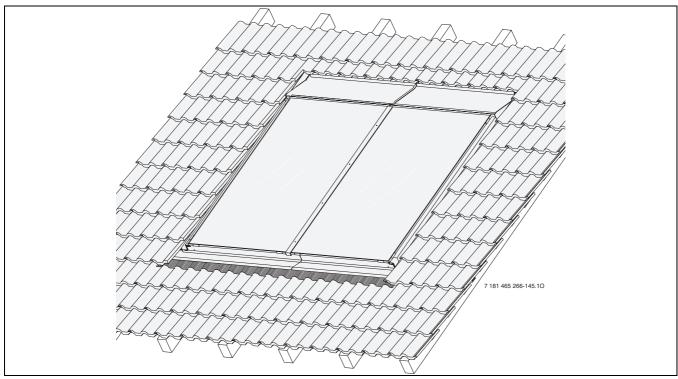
Indachmontage mit zwei Flachkollektoren FKC-1S
